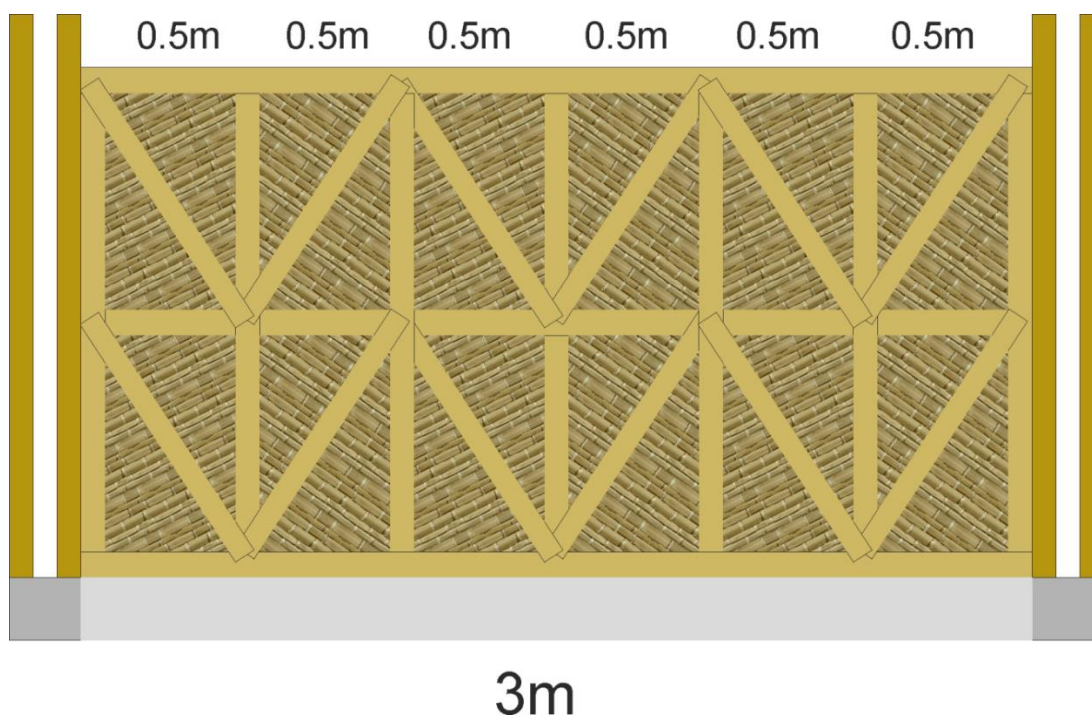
Muro de bahareque. Detalle de entramado. Vista frontal.
